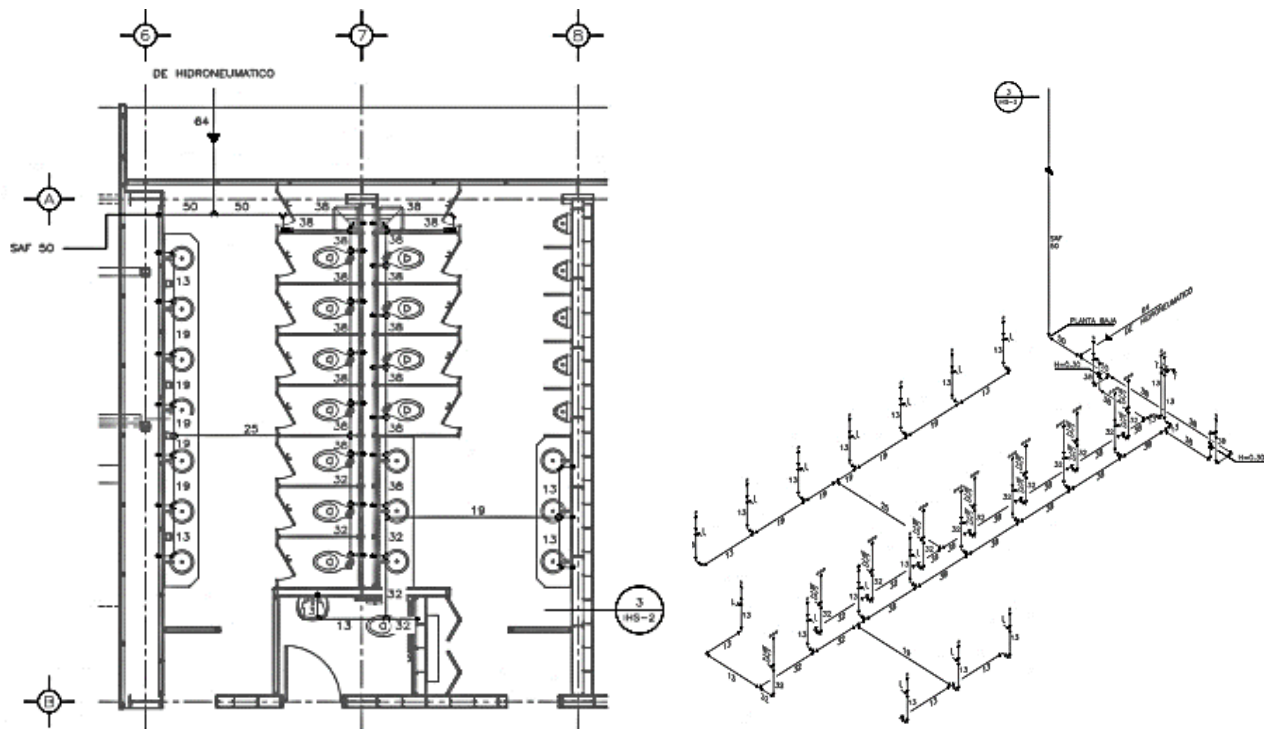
Vista en planta de red hidráulica y levantamiento isométrico en núcleo de baños.
